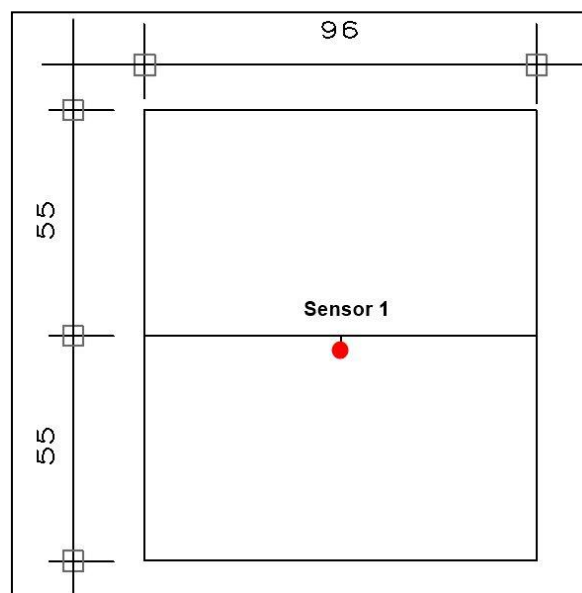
e 26 apresentam a posição vertical e em planta baixa dos sensores (medidas em centímetro).
